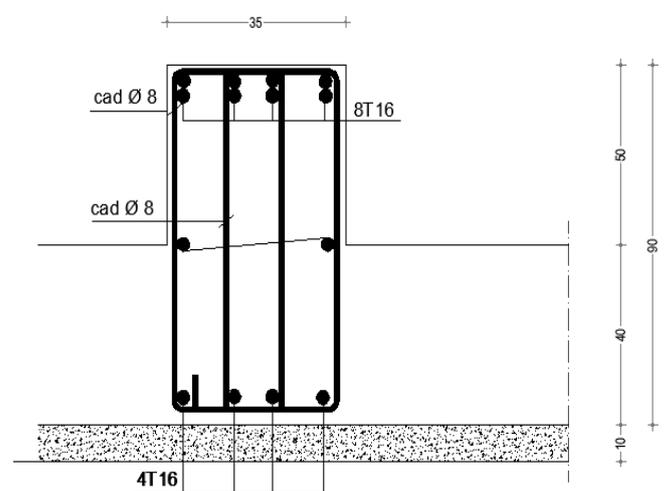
Dessin de ferrailage d'une poutre principale
